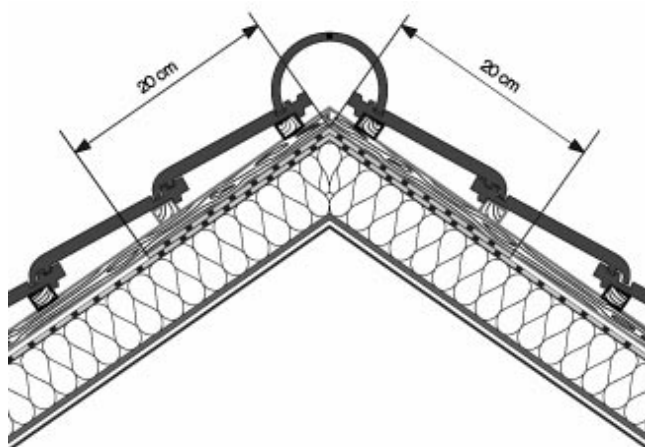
Faîtage - TYVEK® VP'X pose sur panneau sandwich
